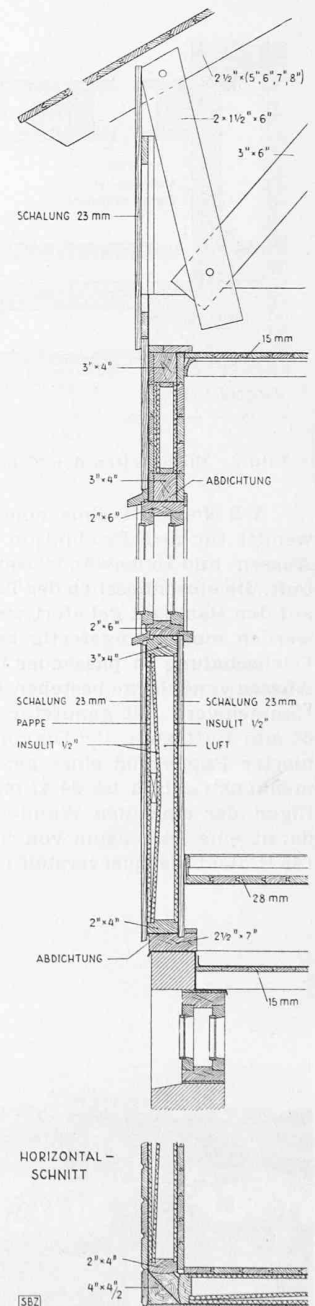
Konstruktion des Hauses Bild 1, Masstab 1:25
